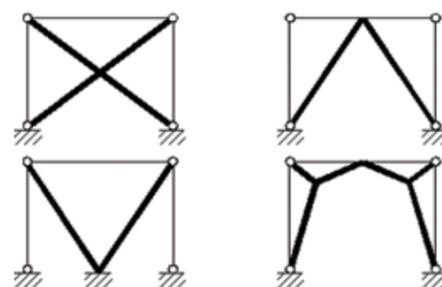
Tipi di controventamento utilizzati nelle strutture in acciaio
